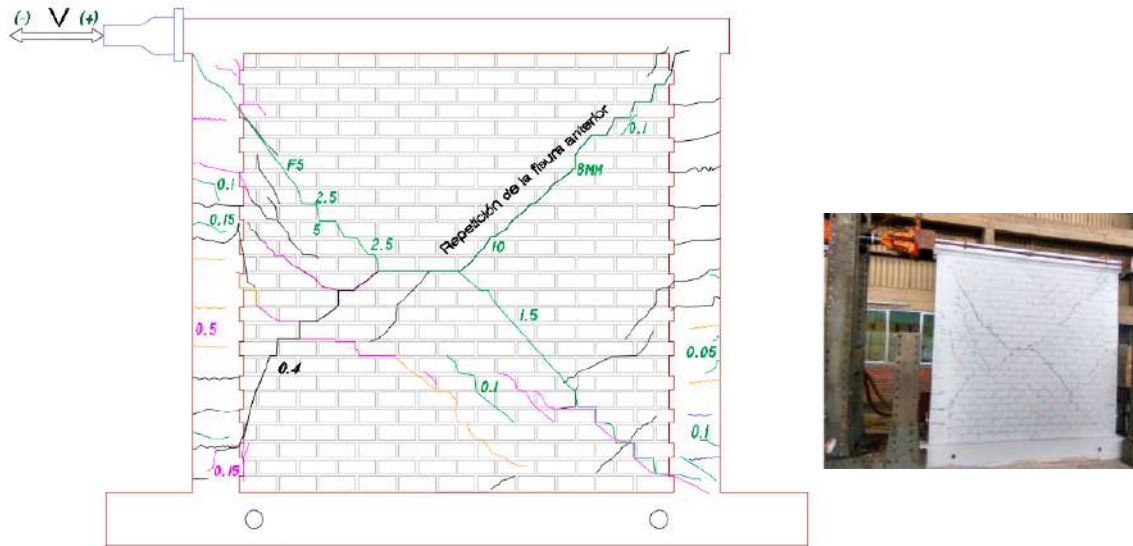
Muro agrietado diagonalmente izquierda en la fase 5.
